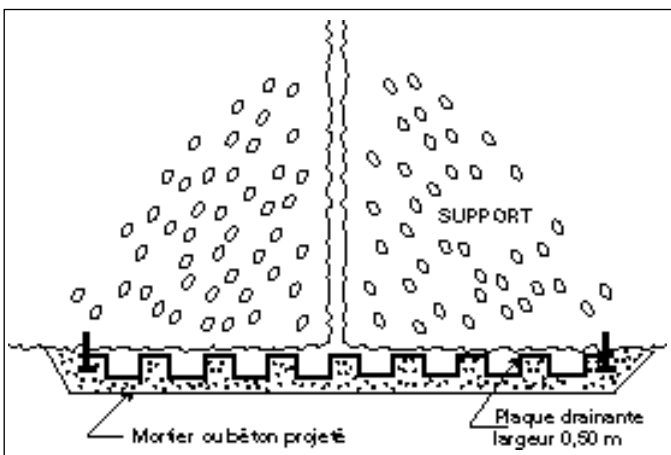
Drainage par bande drainante recouverte par un mortier ou béton projeté
